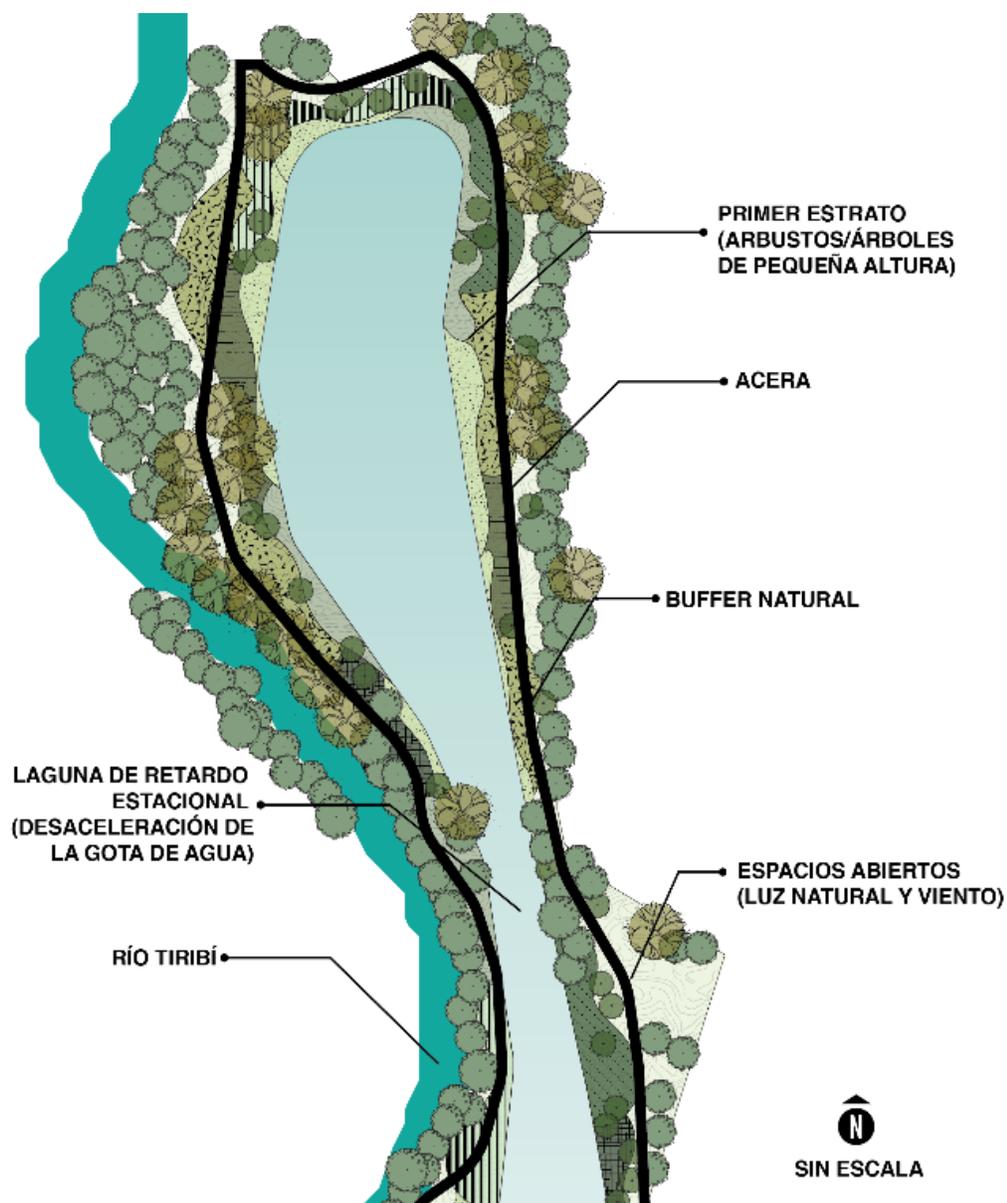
Plano de plantación. Fuente: elaboración propia.
